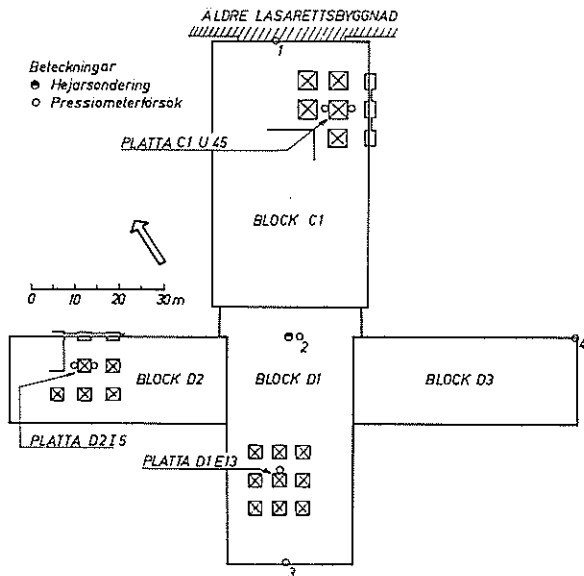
Grundplan. De ofyllda cirklarna anger lägena för pressiometerförsöken
